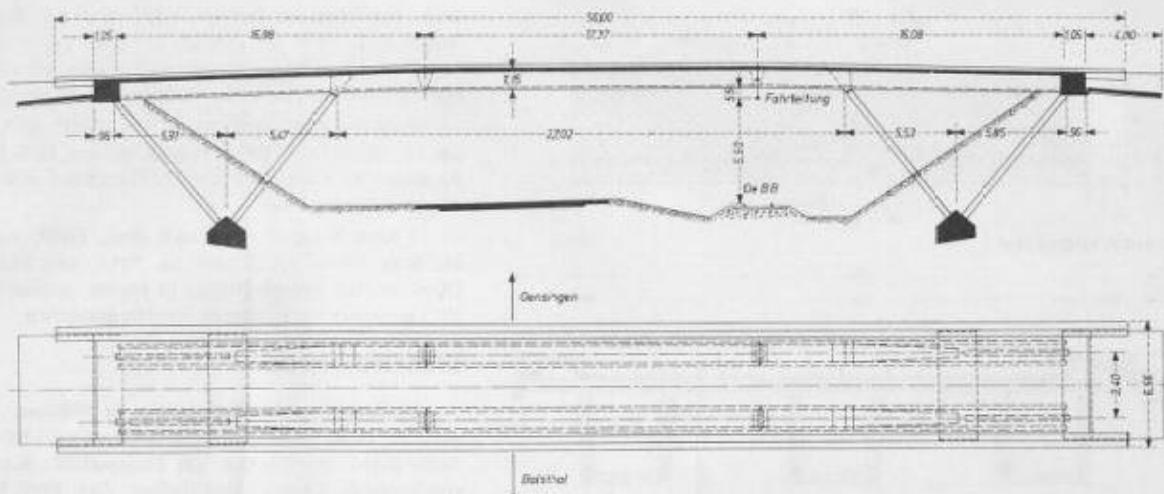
Überführung Oensingen, Längsschnitt und Grundriss 1:400
